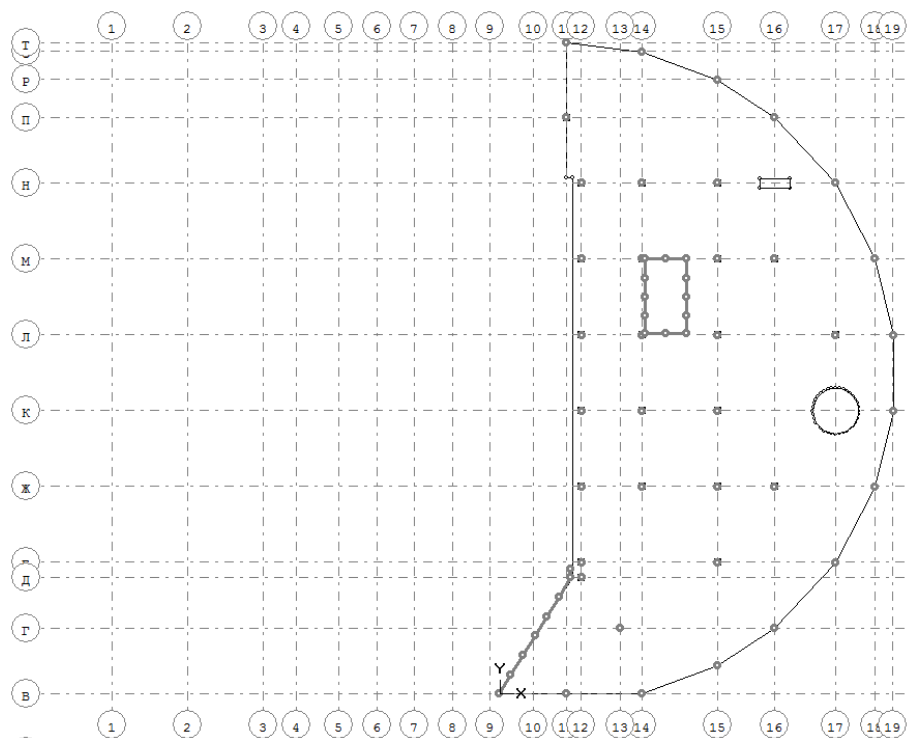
Опалубкове креслення плити перекриття першого поверху Пм-3
